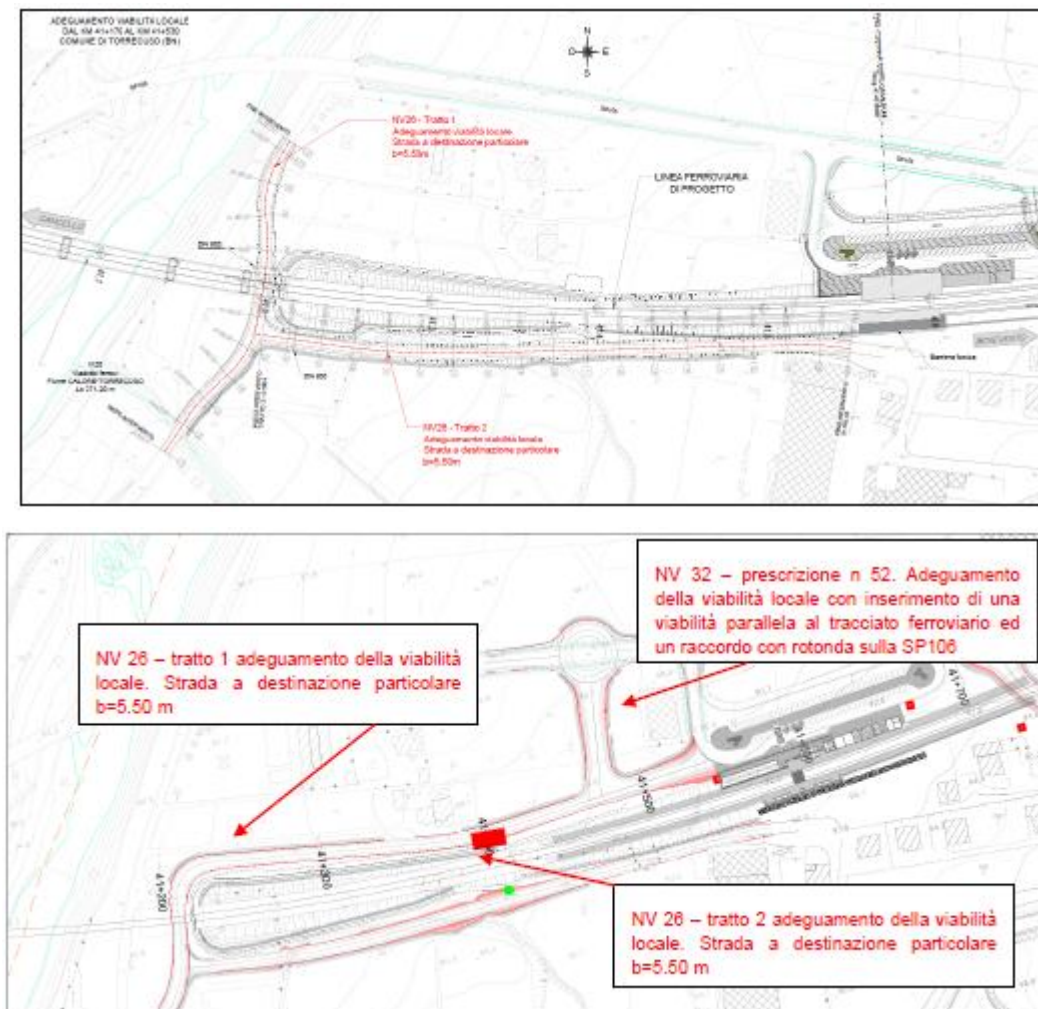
Stralcio planimetria PD (in alto) e PE (in basso)
